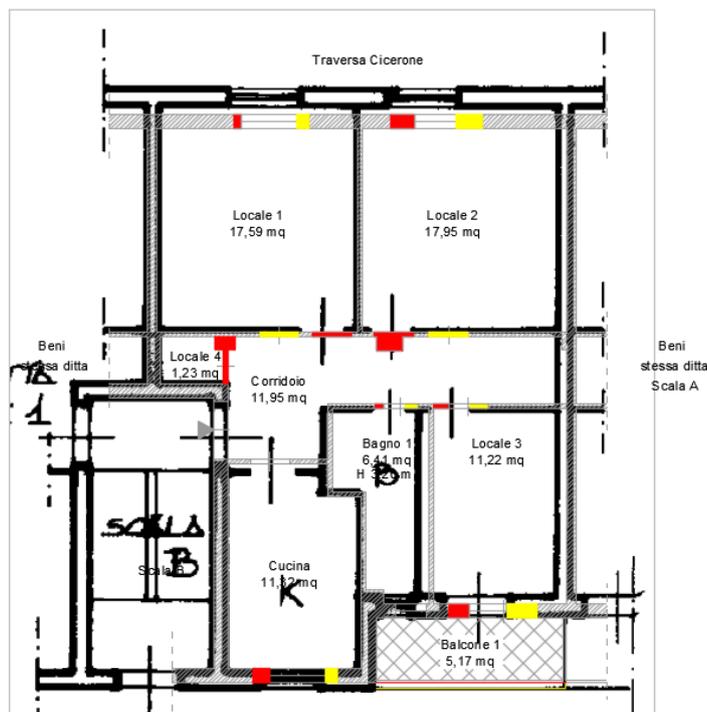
Confronto con planimetria catastale (Foglio 4, p.lla 1225, sub. 8)
